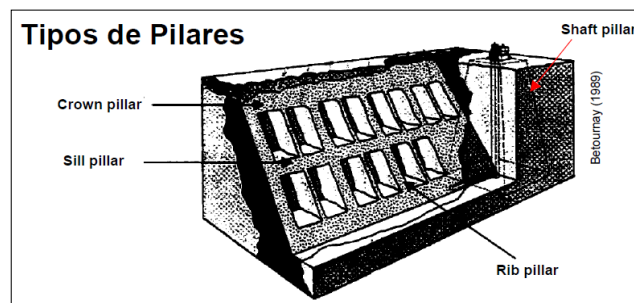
Vista general diseño Sublevel Stoping y tipos de pilares (Betournay, 1989)
